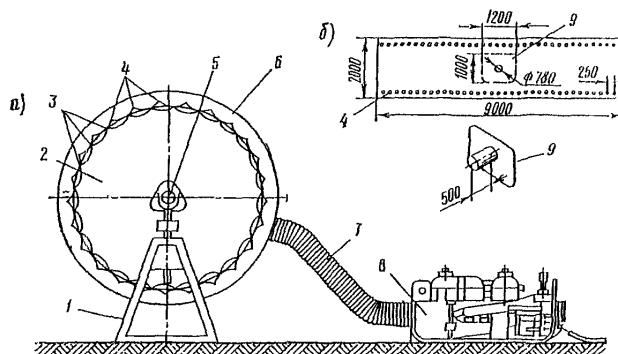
Прогрев кабеля подогревателем ПП-85: а - внешний вид барабана с подогревателем; б - чехол с патрубком; 1 - домкрат; 2 - барабан с кабелем; 3 - шнуровые затяжки; 4 - люверсы брезентового чехла; 5 - стальная ось; 6 - брезентовый чехол с патрубком; 7 - брезентовый рукав; 8 - подогреватель ПП-85; 9 - патрубок
